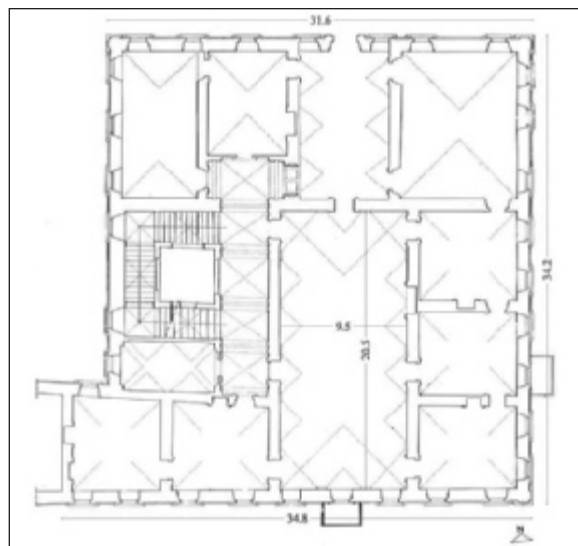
Pianta piano nobile (ricostruzione dello stato originario).
